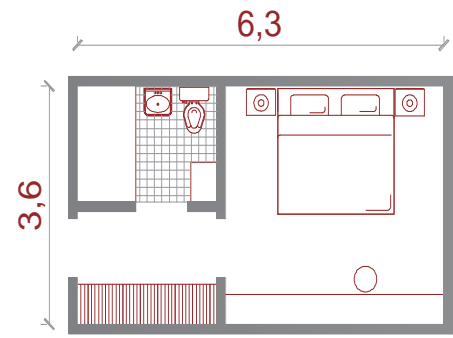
/ Planta habitación tipo de 26,5m² a 43,75m²¹²⁷
